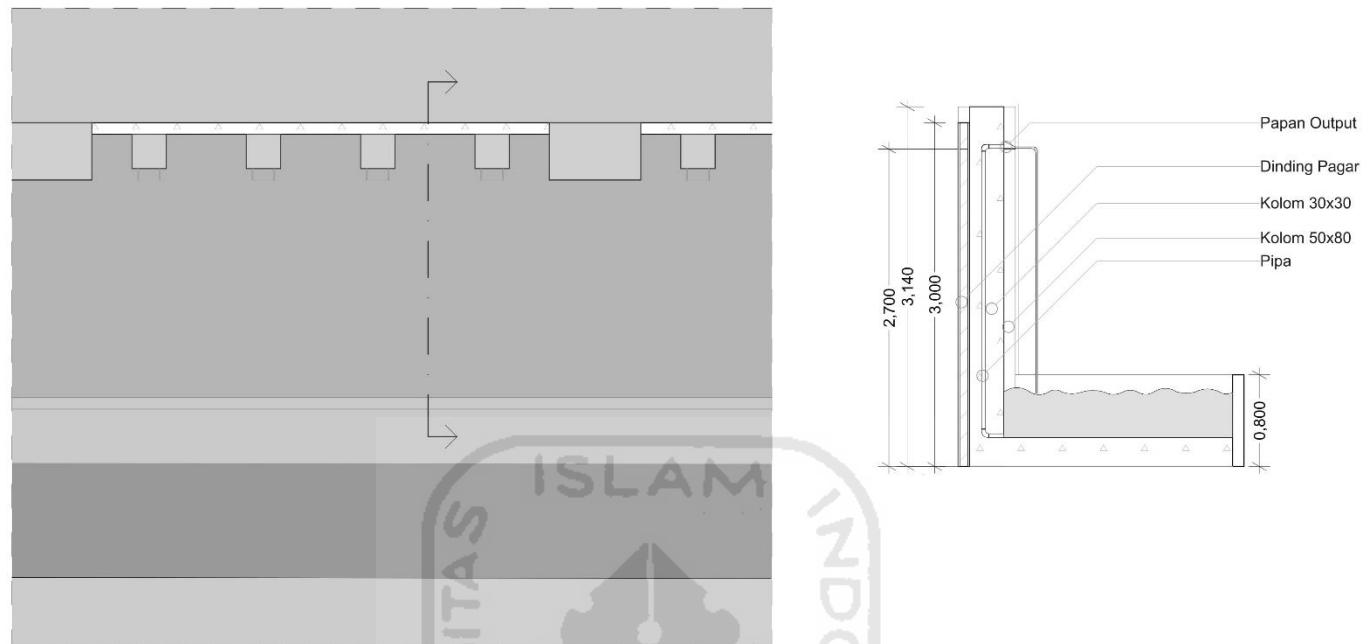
26 Potongan Bangunan Area Rekreasi
